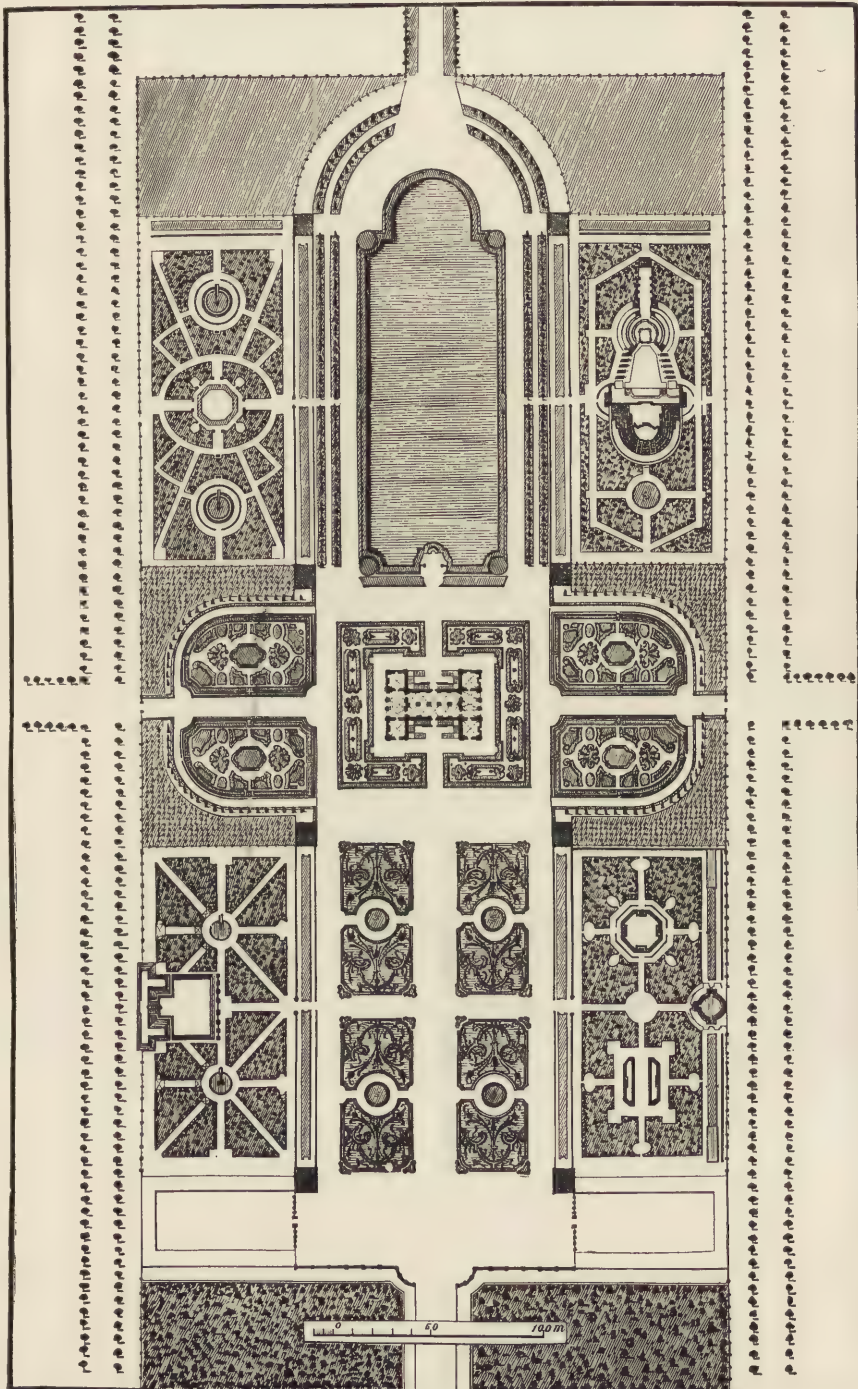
Grosser Garten, Grundriss des Mitteltheiles, Zustand nach 1720.
